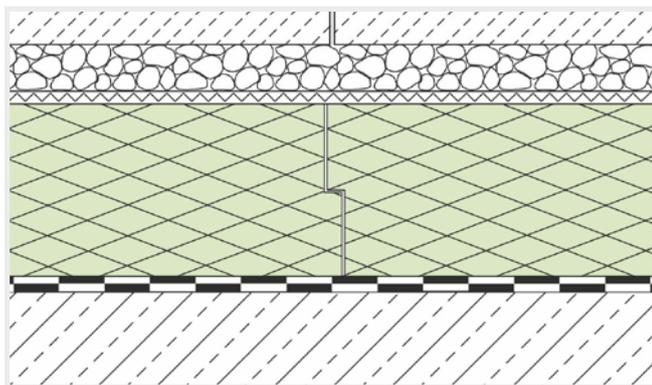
Kiesstreifen am Dachrand und an Dachdurchdringungen.
